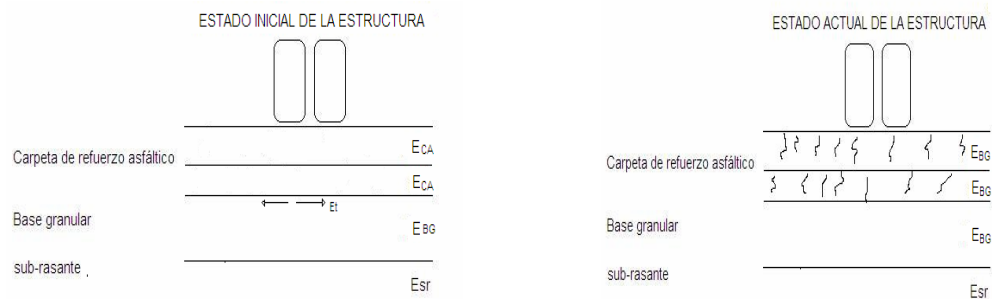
6 Estado inicial y actual supuesto para la estructura de pavimento.
